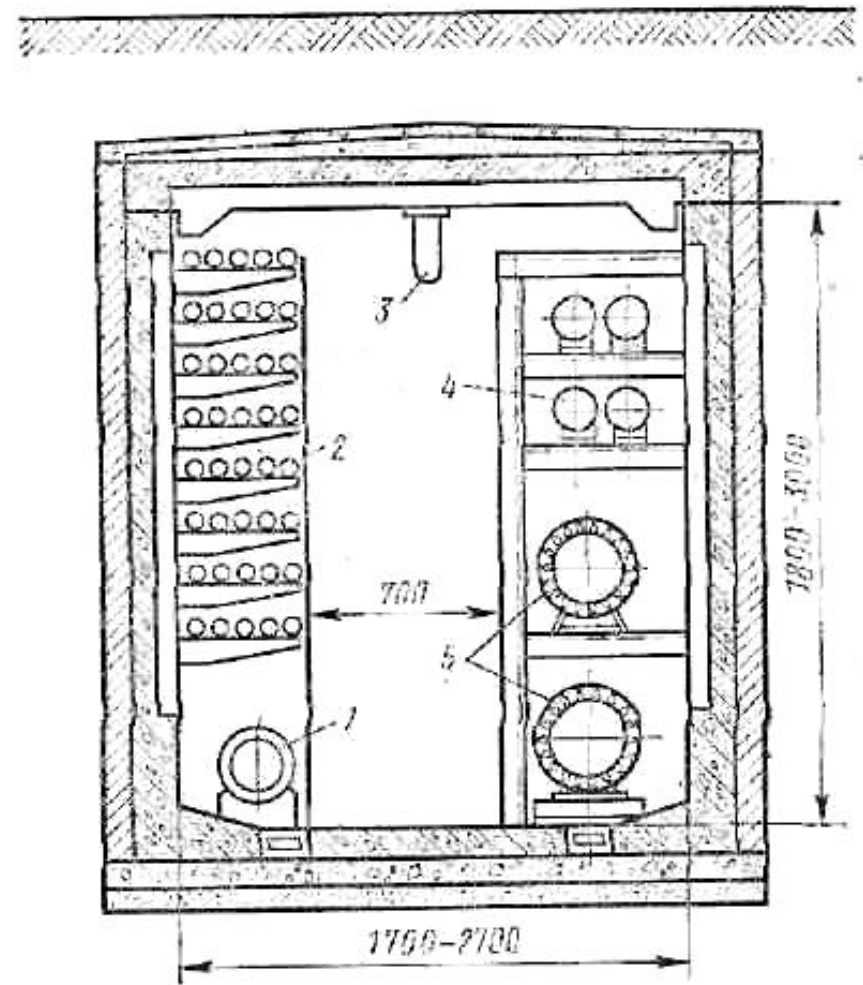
Проходной канал из сборных железобетонных блоков:
